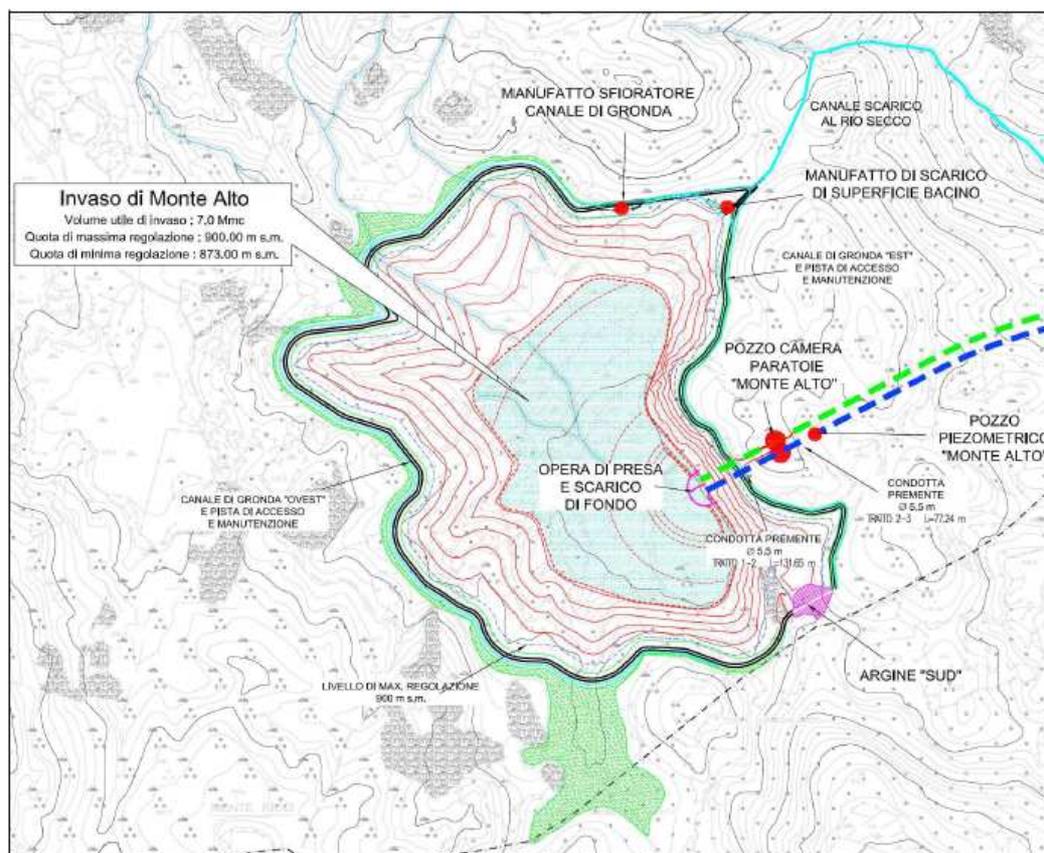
Stralcio planimetrico delle opere in progetto sul bacino di Monte Alto
